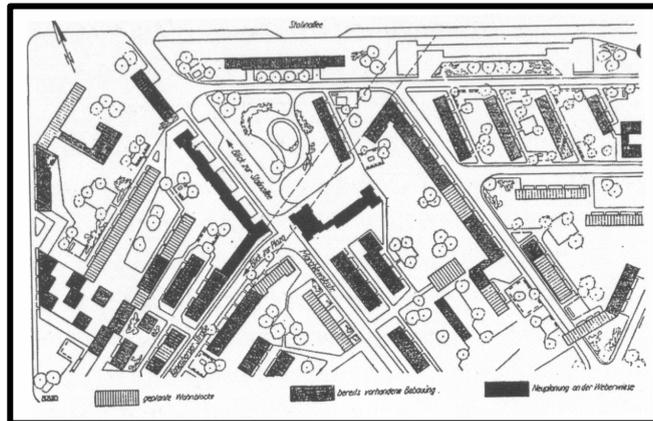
Lageplan der Wohnbauten an der Weberwiese (NICOLAUS/OBETH 1997, S. 88)
